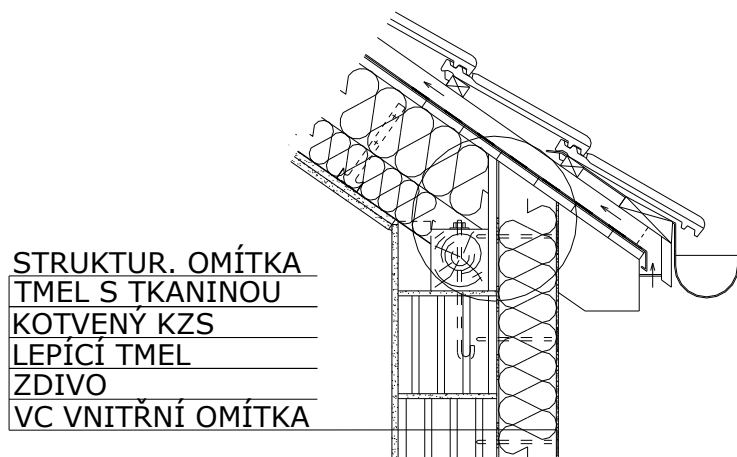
Detail založení KZS v návaznosti na stropní konstrukci [57, 58, autor]
